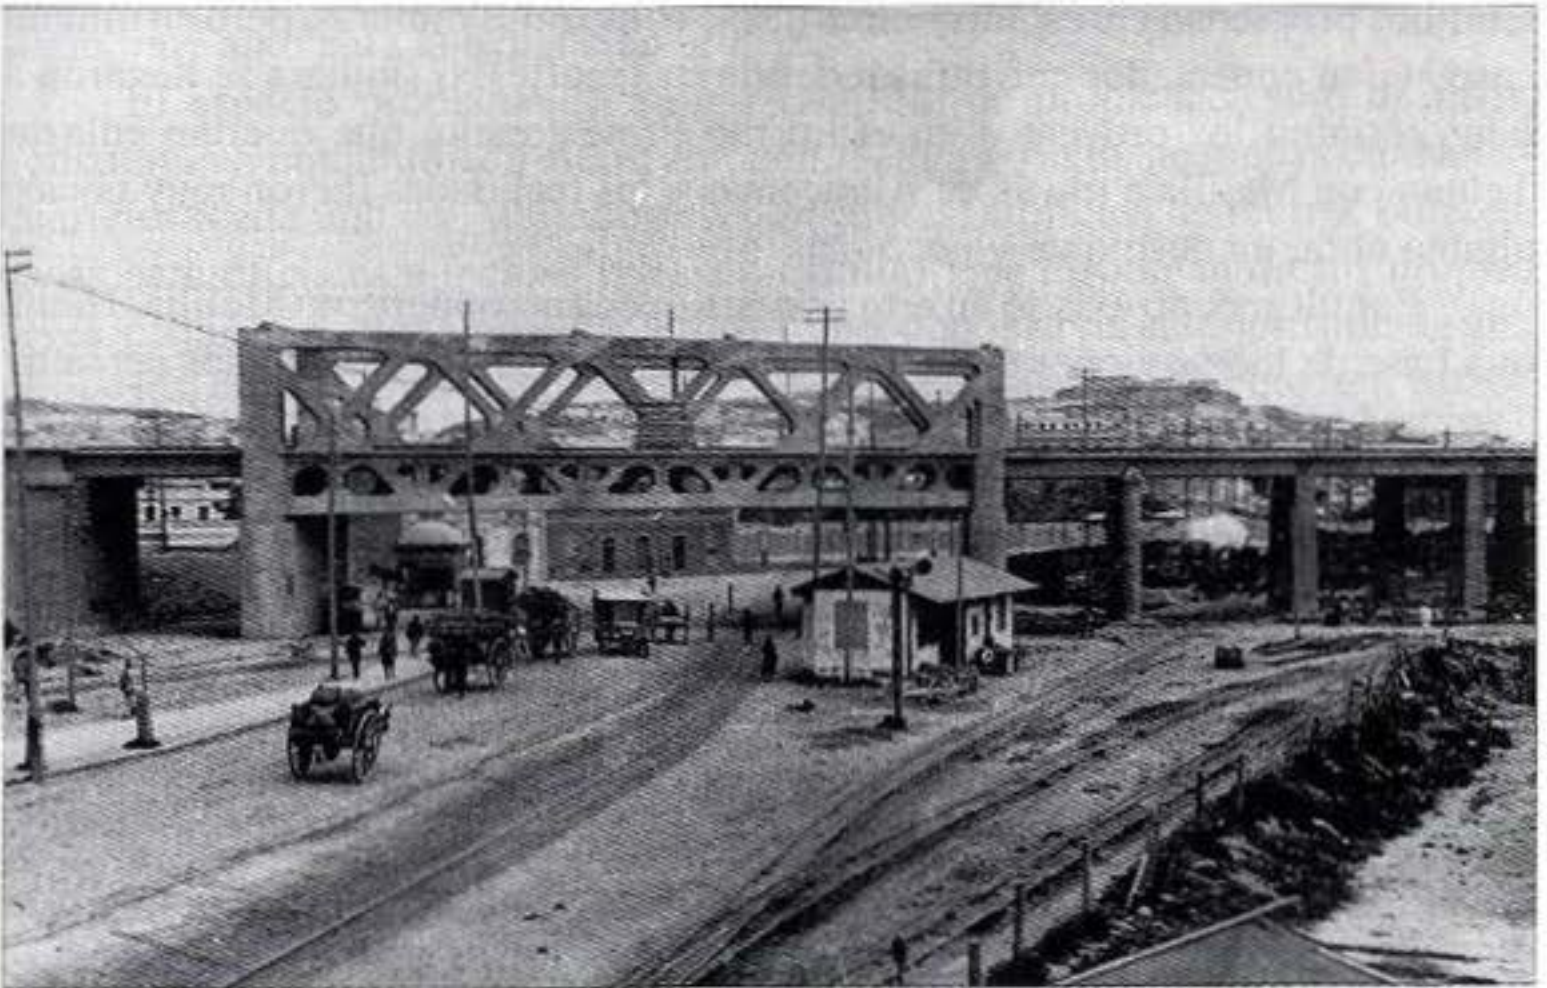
Paso elevado de hormigón armado del cargadero de Minerales de Melilla, CEMR., años veinte. APFC.
